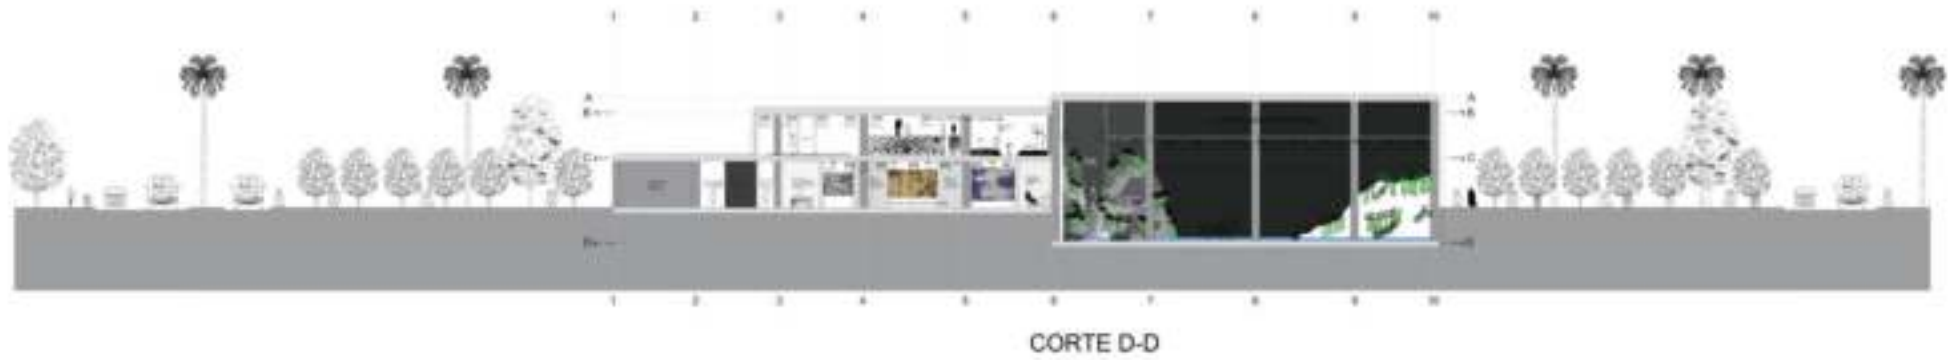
corte d-d proyecto arquitectónico en altura.
